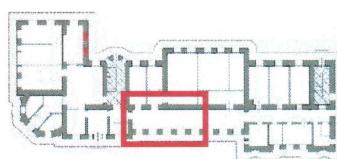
Междуэтажные плоские перекрытия, кирпичные перемычки оконных, дверных проемов
